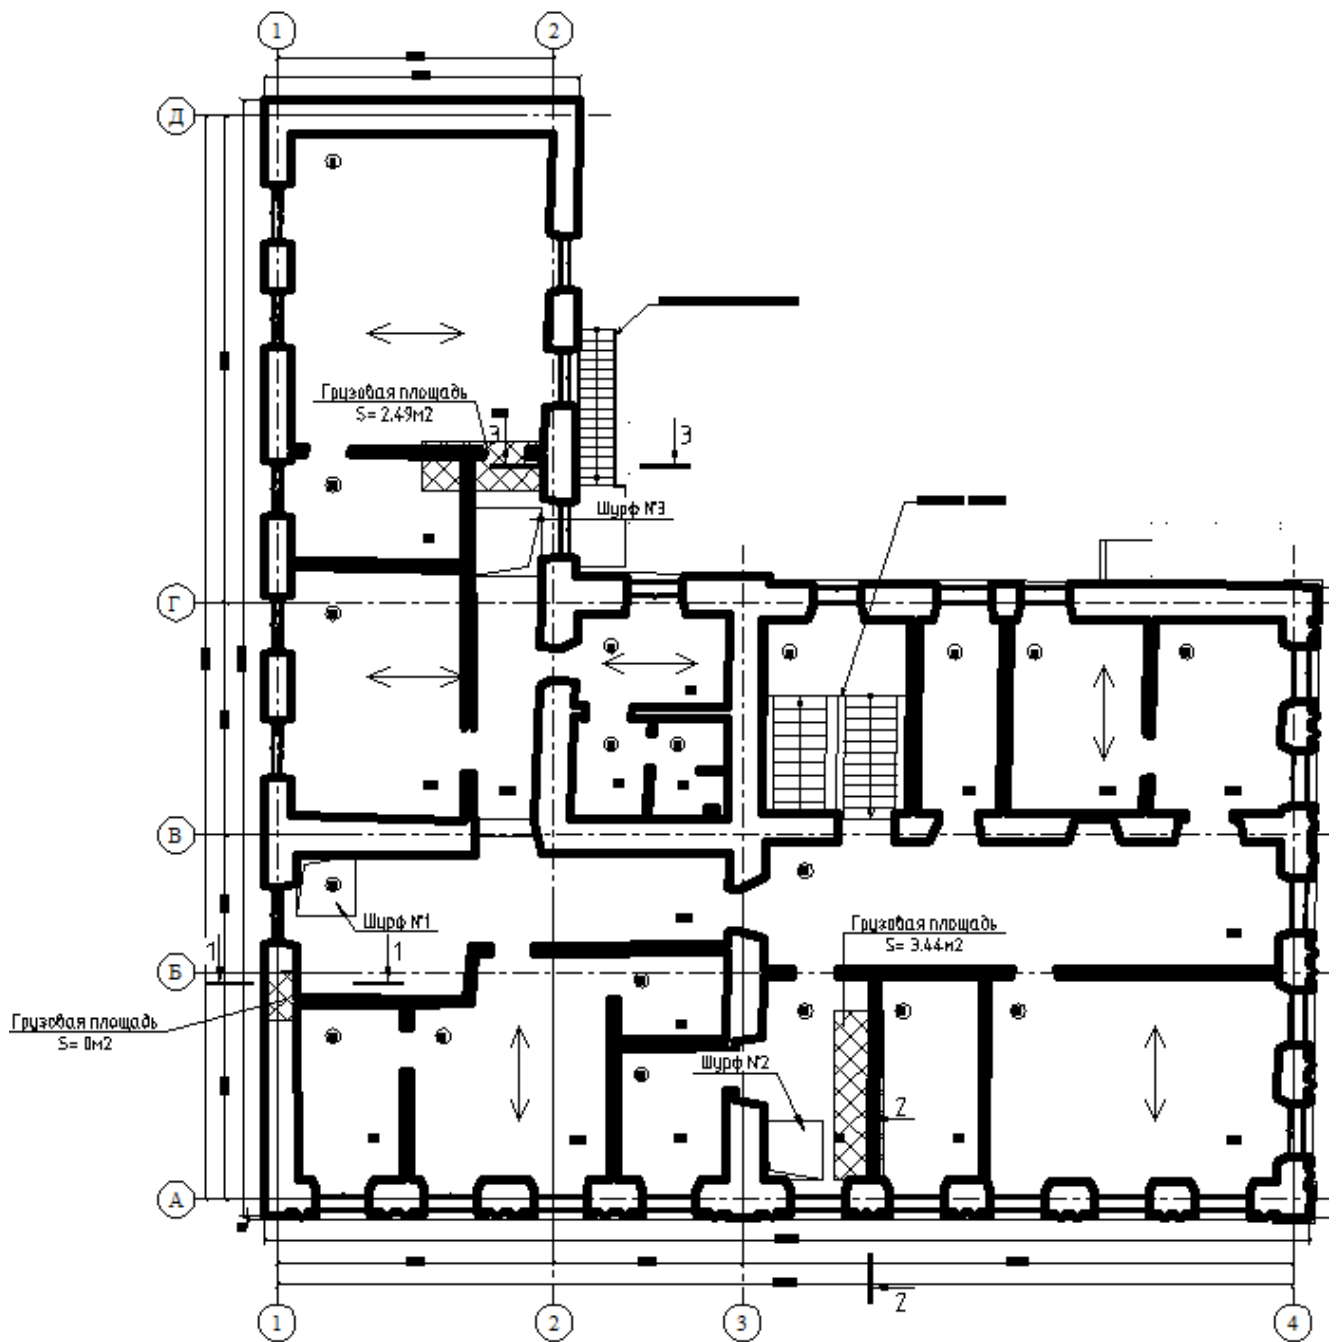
Схема расположения расчетных сечений для сбора нагрузок на фундамент.
